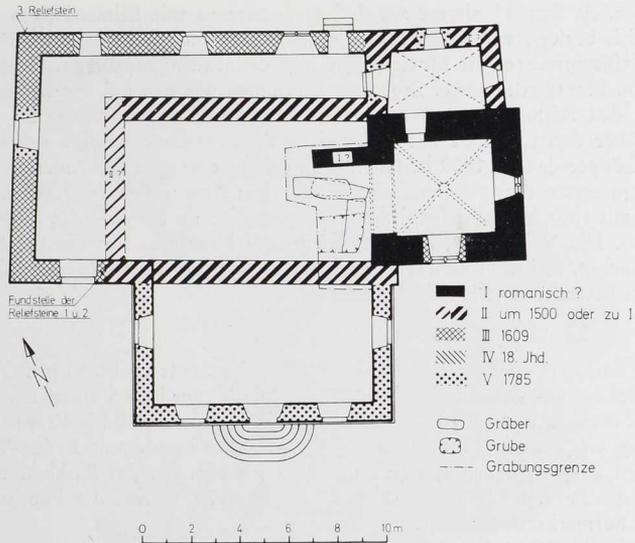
Nöttingen (Lkr. Pforzheim). Evangelische Pfarrkirche St. Martin; Grundriß mit Befunden.
